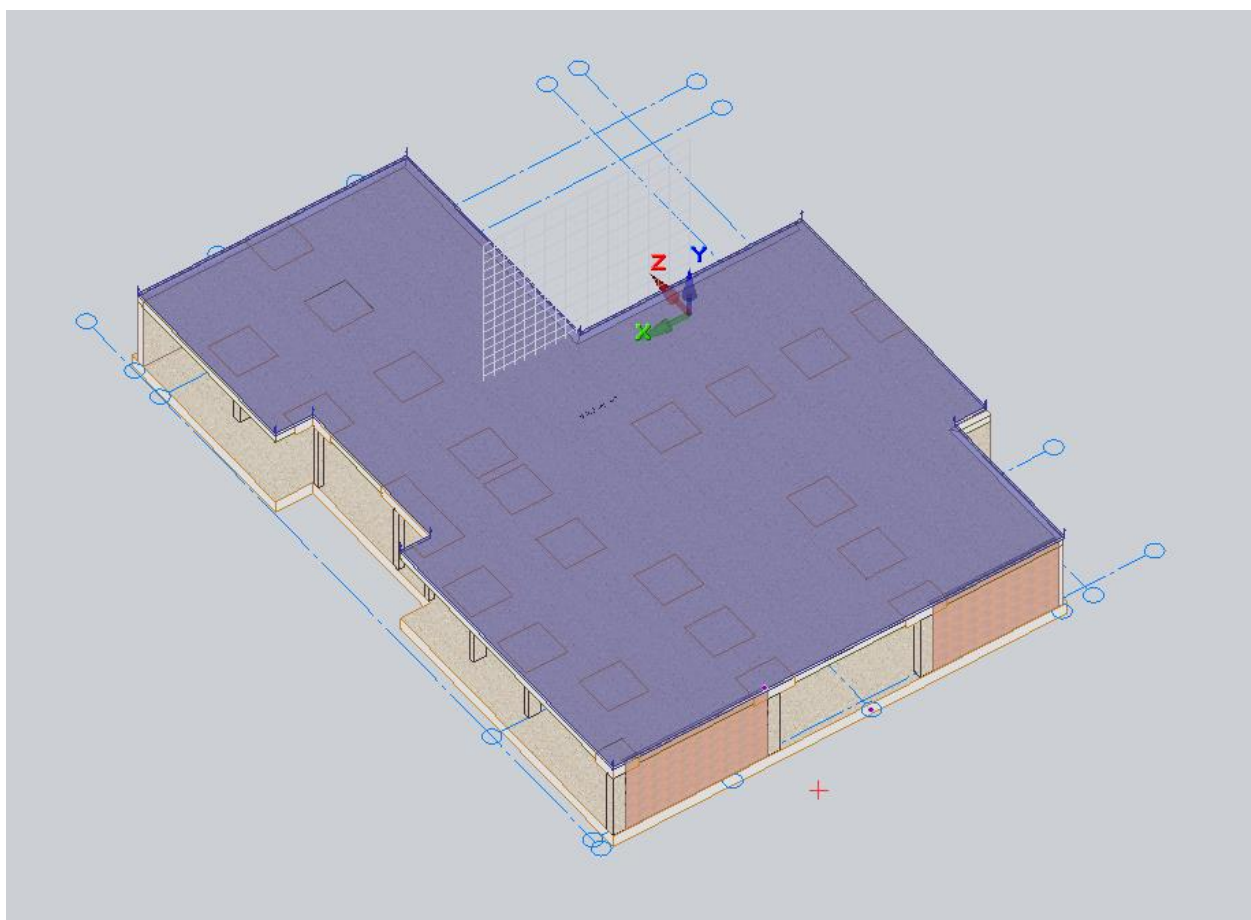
План перекриття з розташуванням несучих колон
